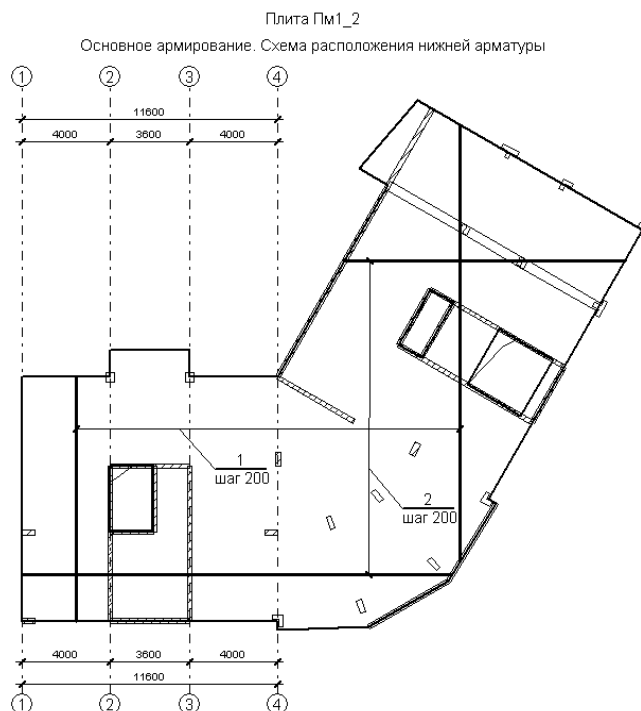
Схема раскладки стержней основного армирования, стиль для печати (фрагмент)
